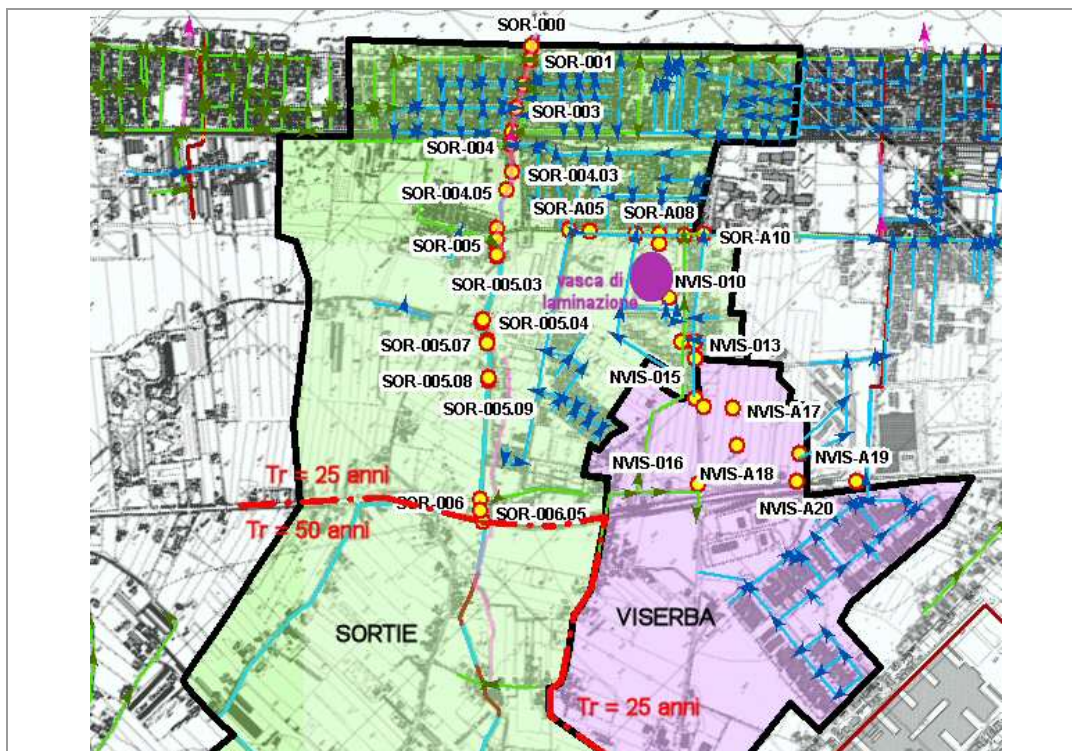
Planimetria dei bacini Sortie e Viserba
